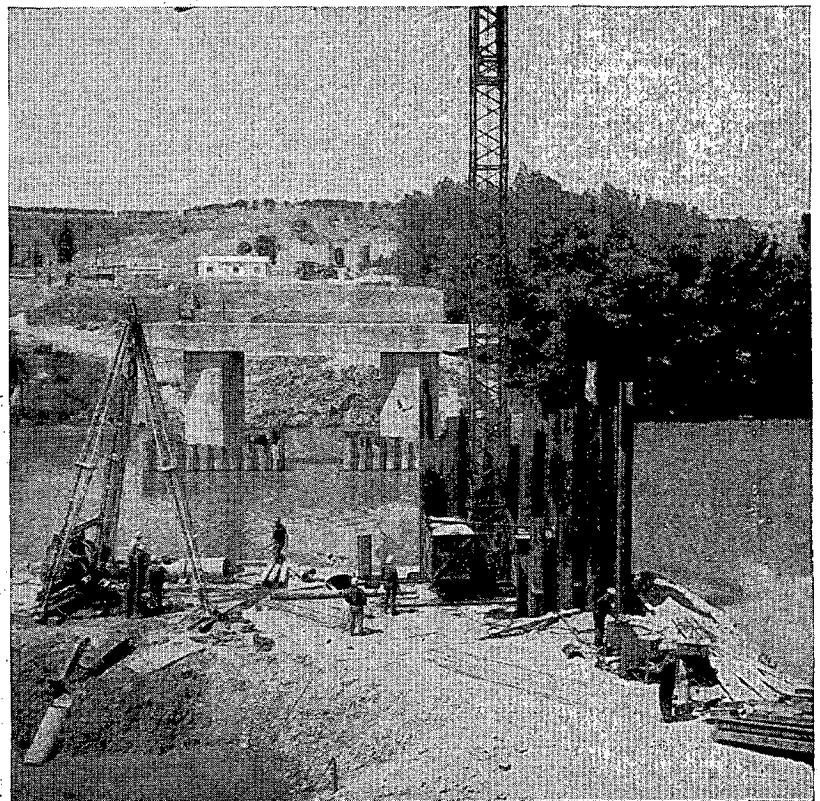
Cimentación de un puente por el sistema mixto de recinto formado por tablestacas metálicas y pilotes de hormigonados *in situ* ejecutados en su interior, construido sobre el río Pisuerga, en Valladolid.
